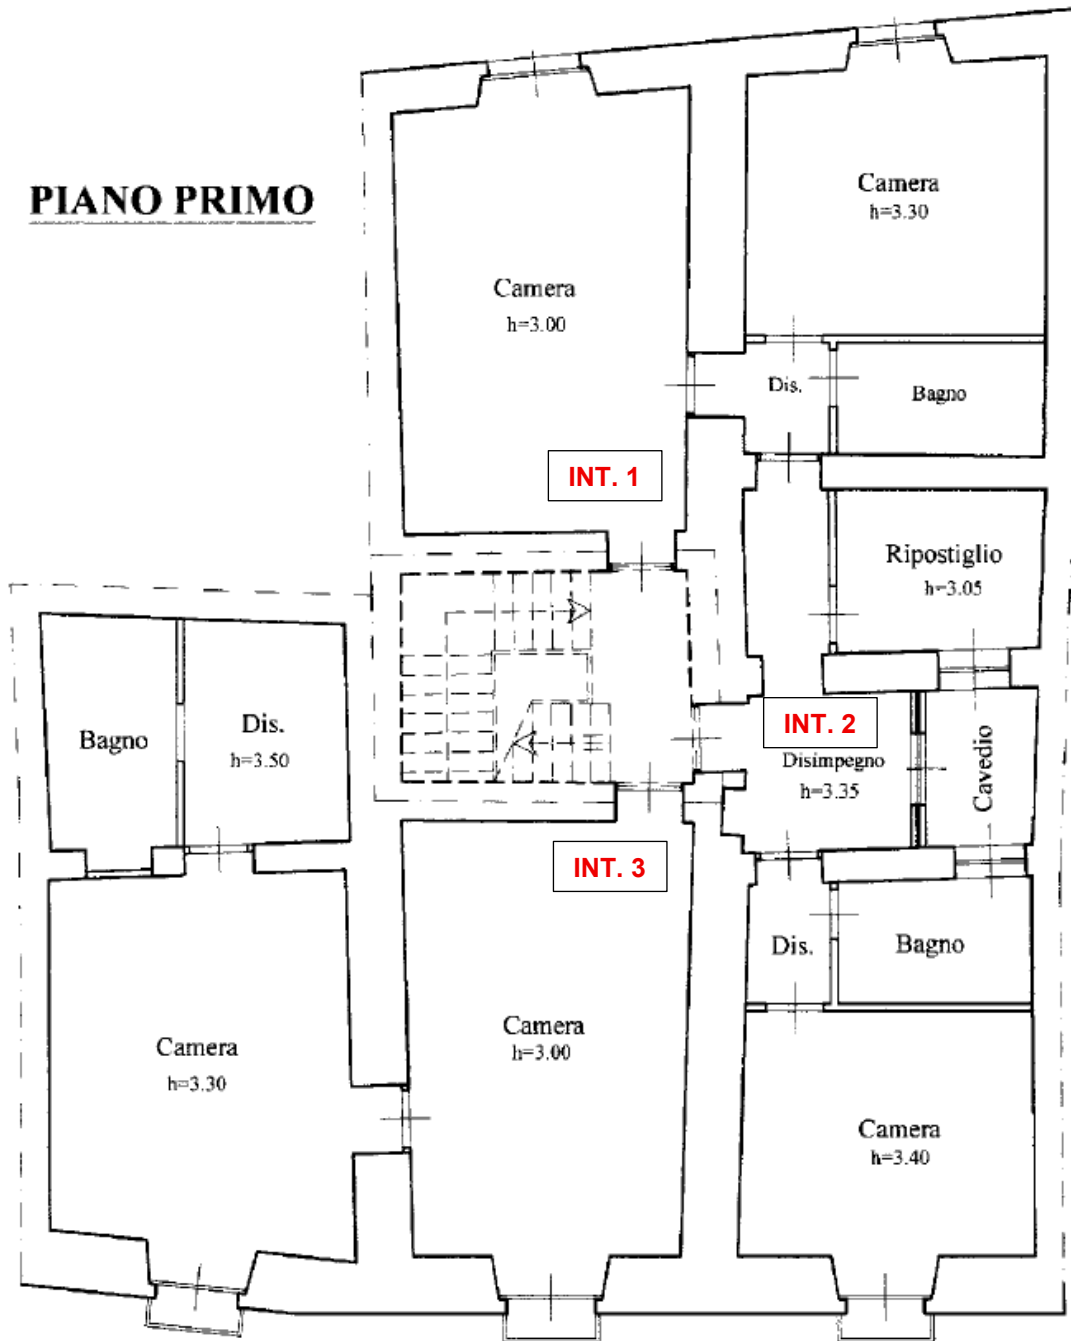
Lotto 2, stralcio della planimetria catastale in atti (fuori scala) del primo piano
